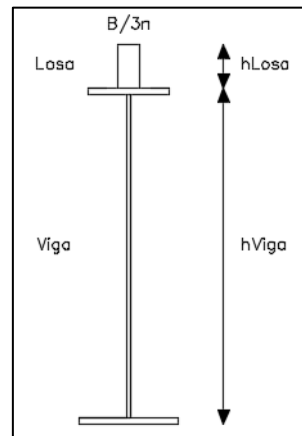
Sección Compuesta viga-losa (Segundo estado de carga)
